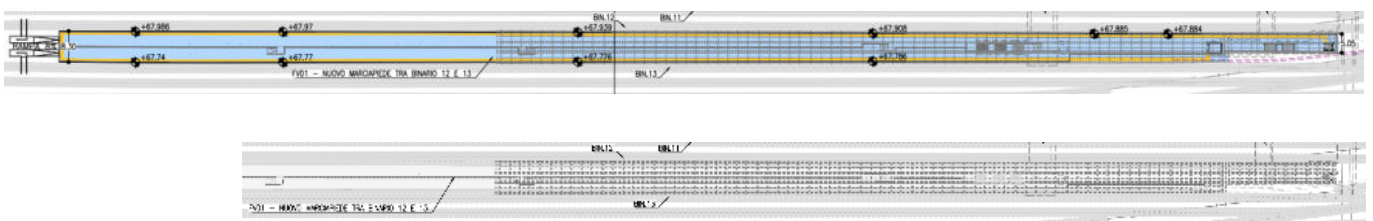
FV01 – Stralcio planimetrico del marciapiede e della tettoia
